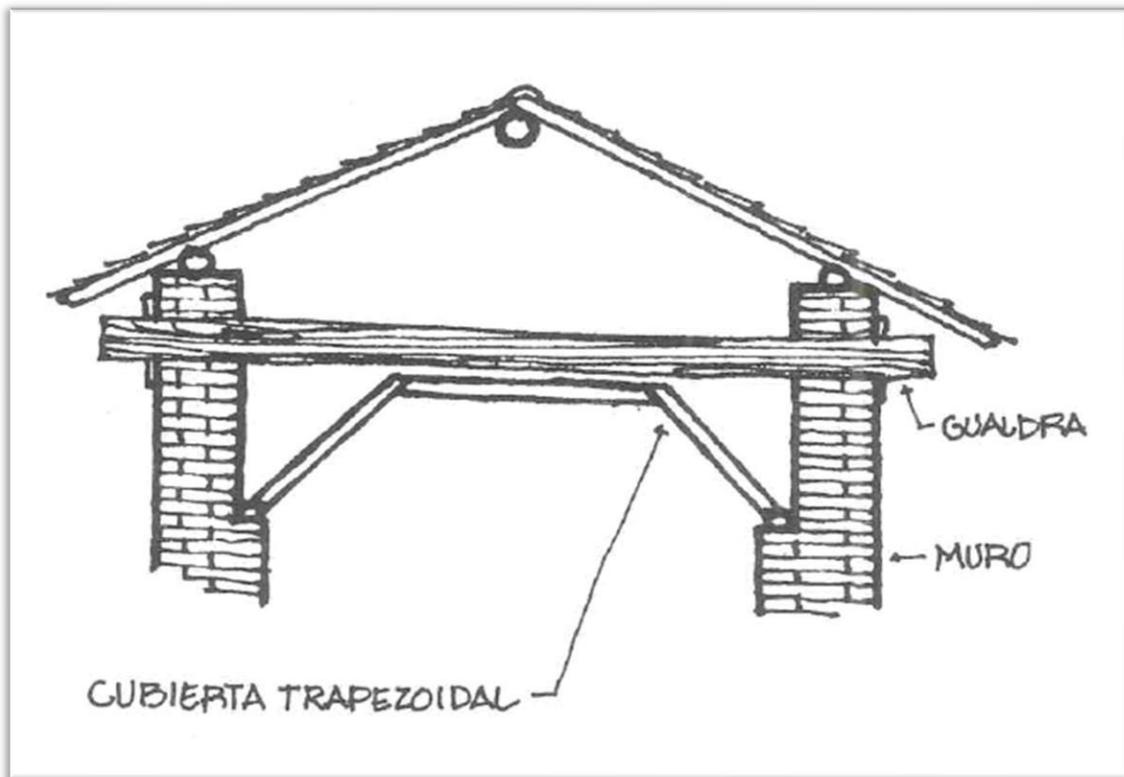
Detalles del sistema de cerchones y tablonés de forma trapezoidal sin variante de navéculas<sup>133</sup>
